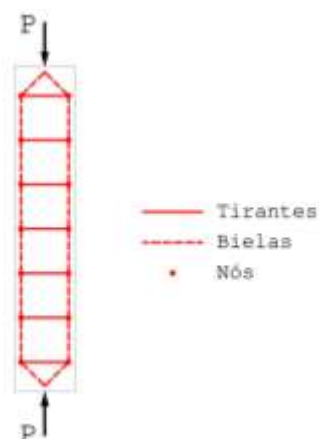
Modelo de bielas e tirantes para pilar sob compressão axial centrada
